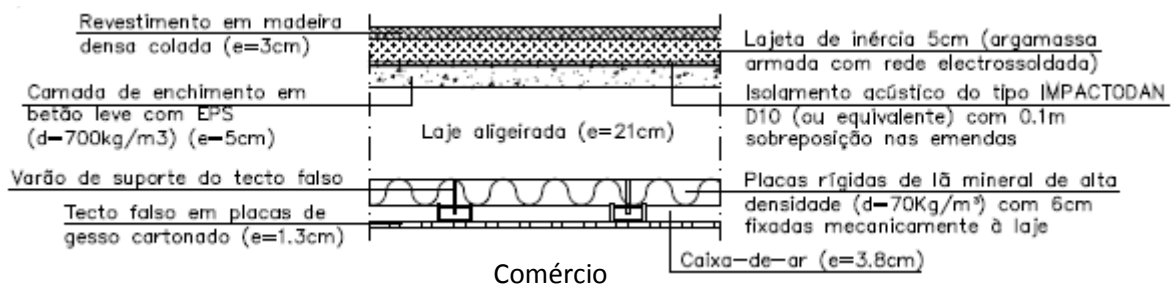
Pormenor construtivo do pavimento 4 [17]
